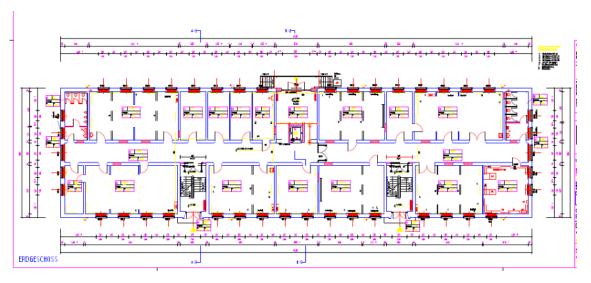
Grundrissplan Erdgeschoss, Gebäude FC
